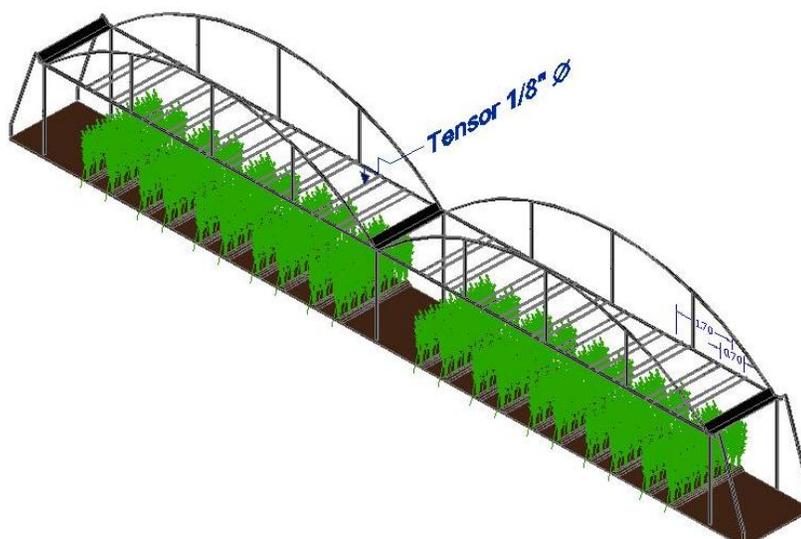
Tensores, elementos estructurales que sostiene las plantas
